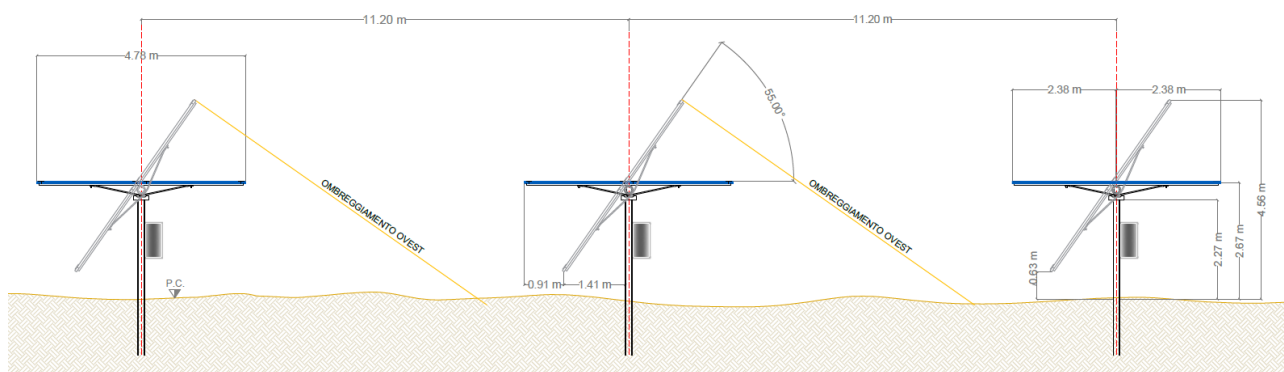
Vista frontale con rotazione di 55° ovest e distanza longitudinale tra le strutture
